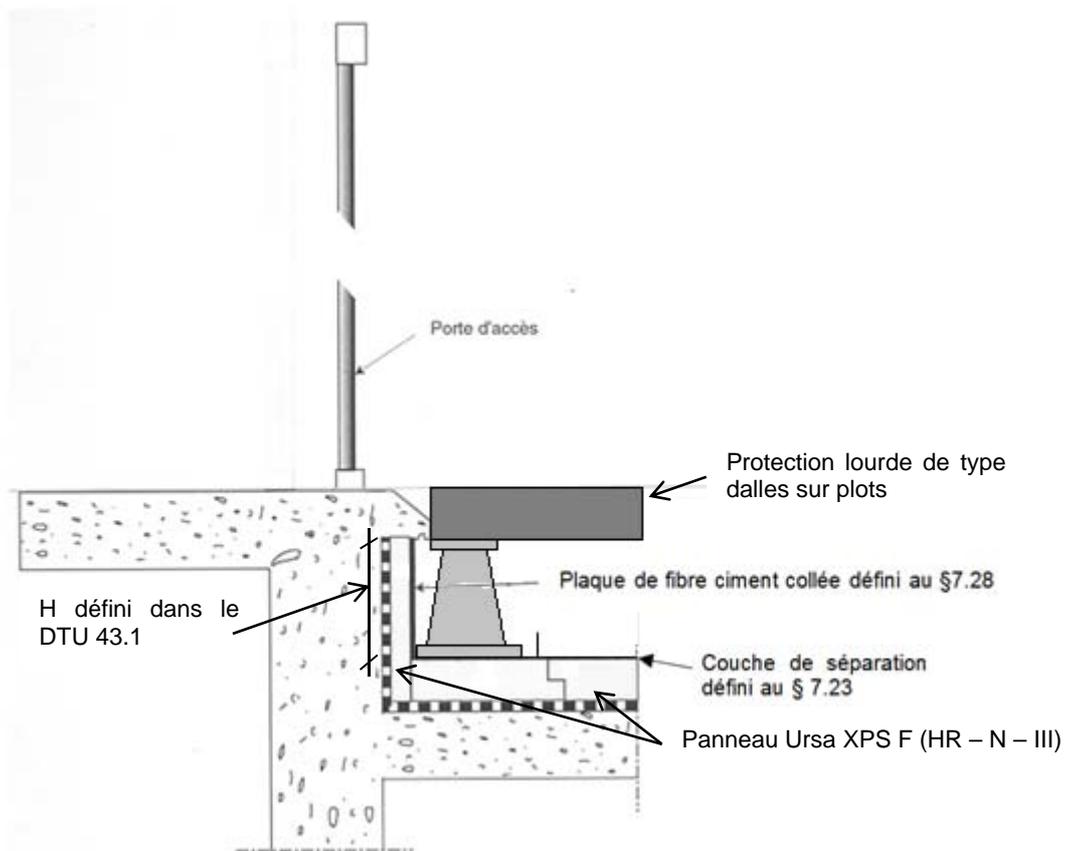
Protection des relevés par Ursa XPS F (HR – N-III) et plaque rigide fibres-ciment sur un passage de porte
